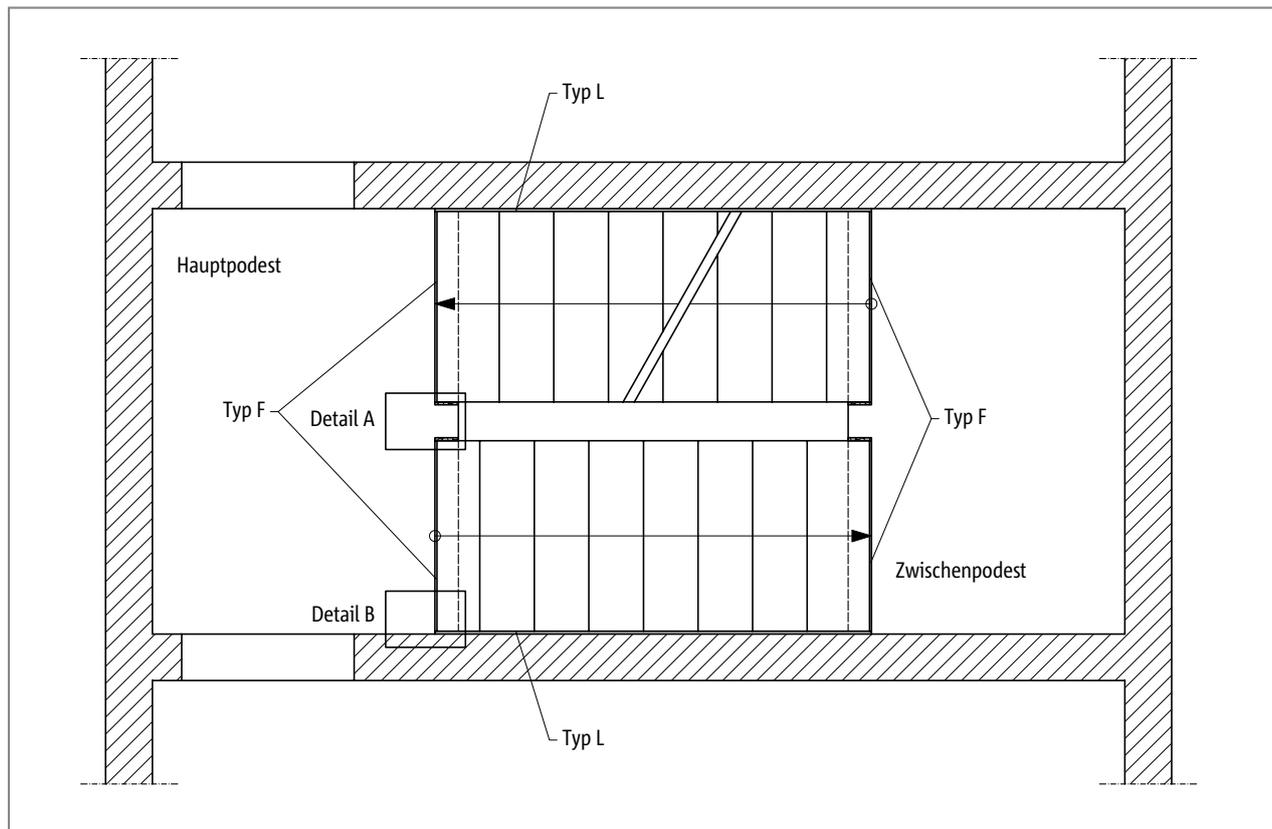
Schöck Tronsole® Typ F: Elementanordnung im Grundriss
